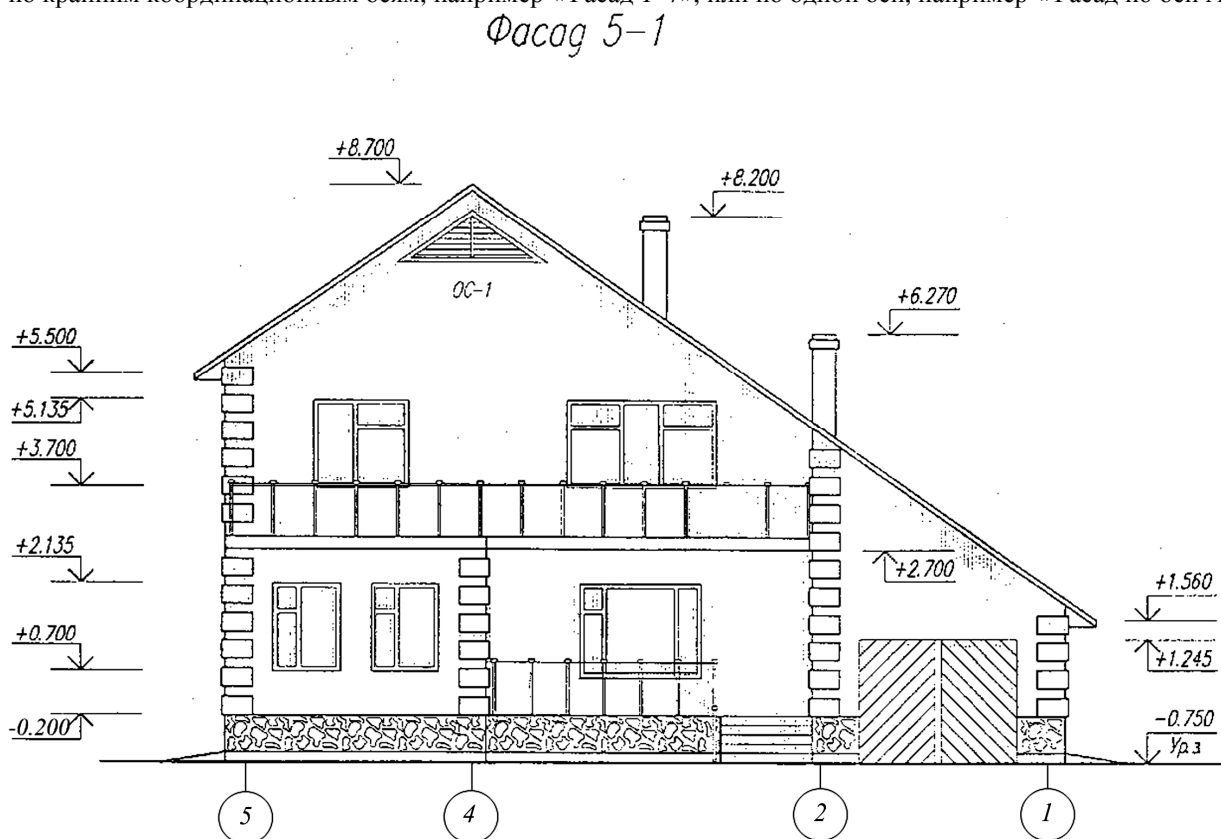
Пример выполнения фасада малоэтажного жилого здания
